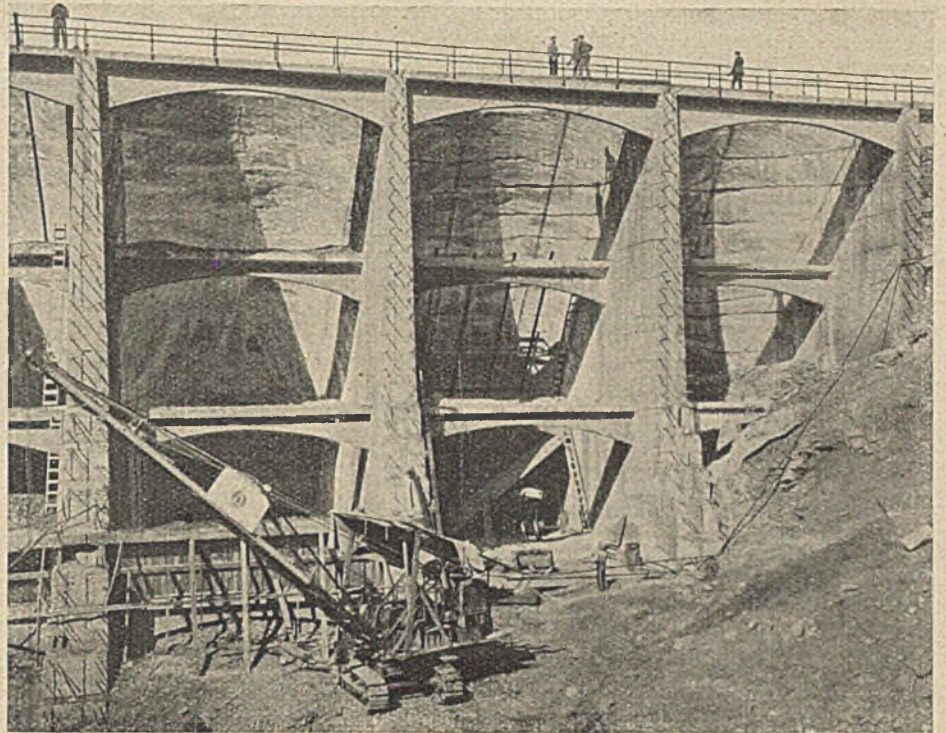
Zerstörungen an einer Eisenbetontalsperre.
